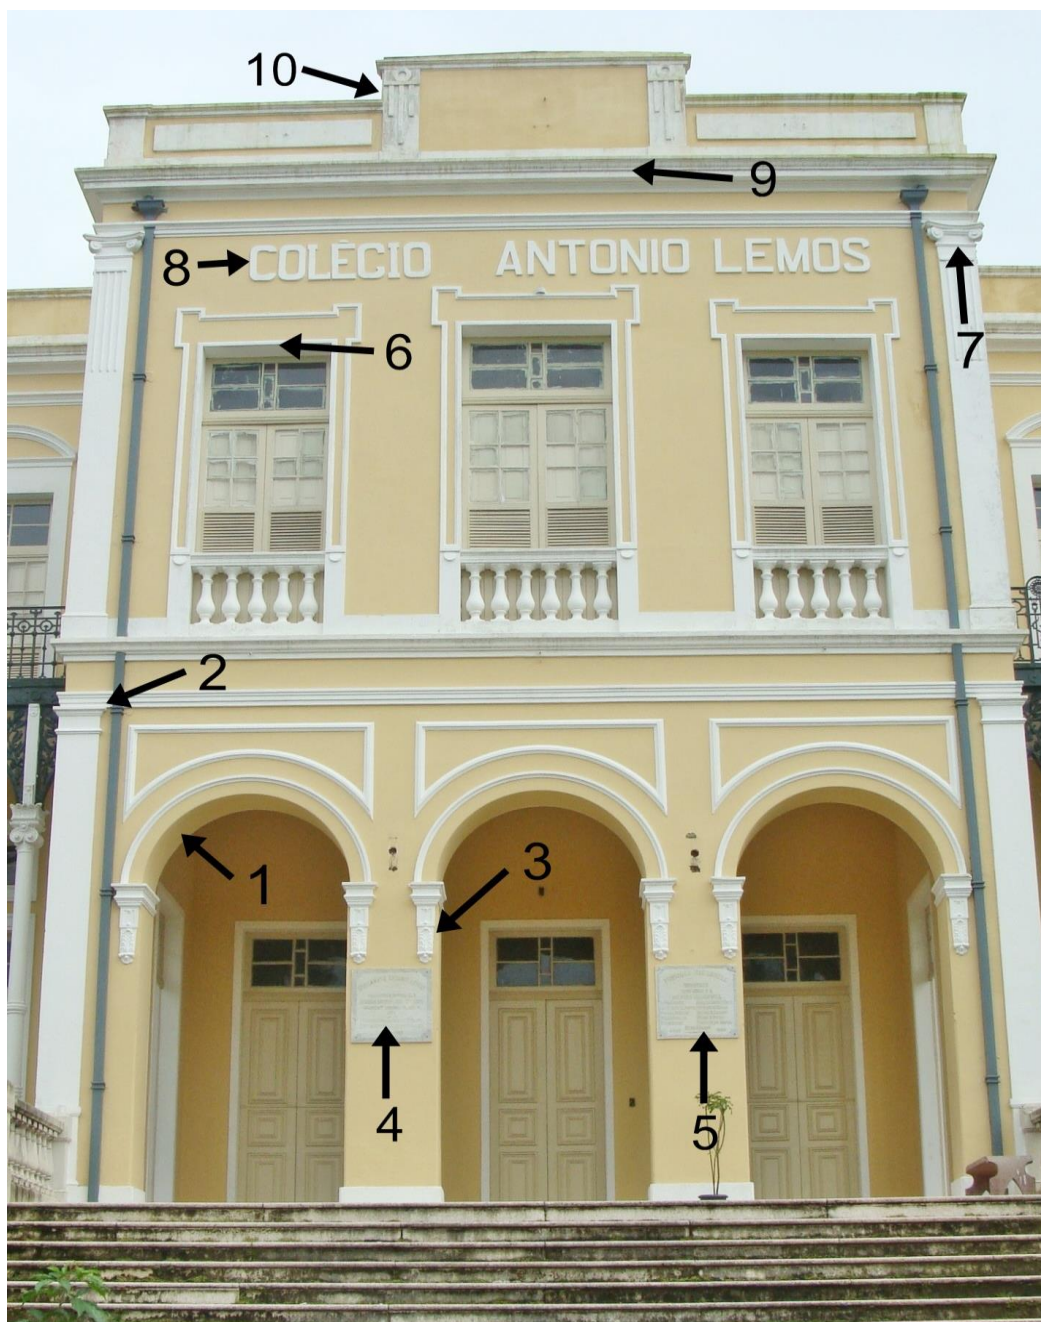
Parte Central da Fachada do Prédio. 1 - Arco Pleno; 2 - Capitel seguindo a ordem Dórica; 3 - Folha de acanto; 4 - Placa indicando o ano de construção do prédio; 5 - Placa indicando a presença da Fundação Mac-Dowell. 6 - Verga reta; 7 - Capitel seguindo a ordem Jônica; 8 - Nome atual da Instituição em relevo; 9 - Cornija; 10 - Ornato. Fonte: Acervo da autora. 2015.
